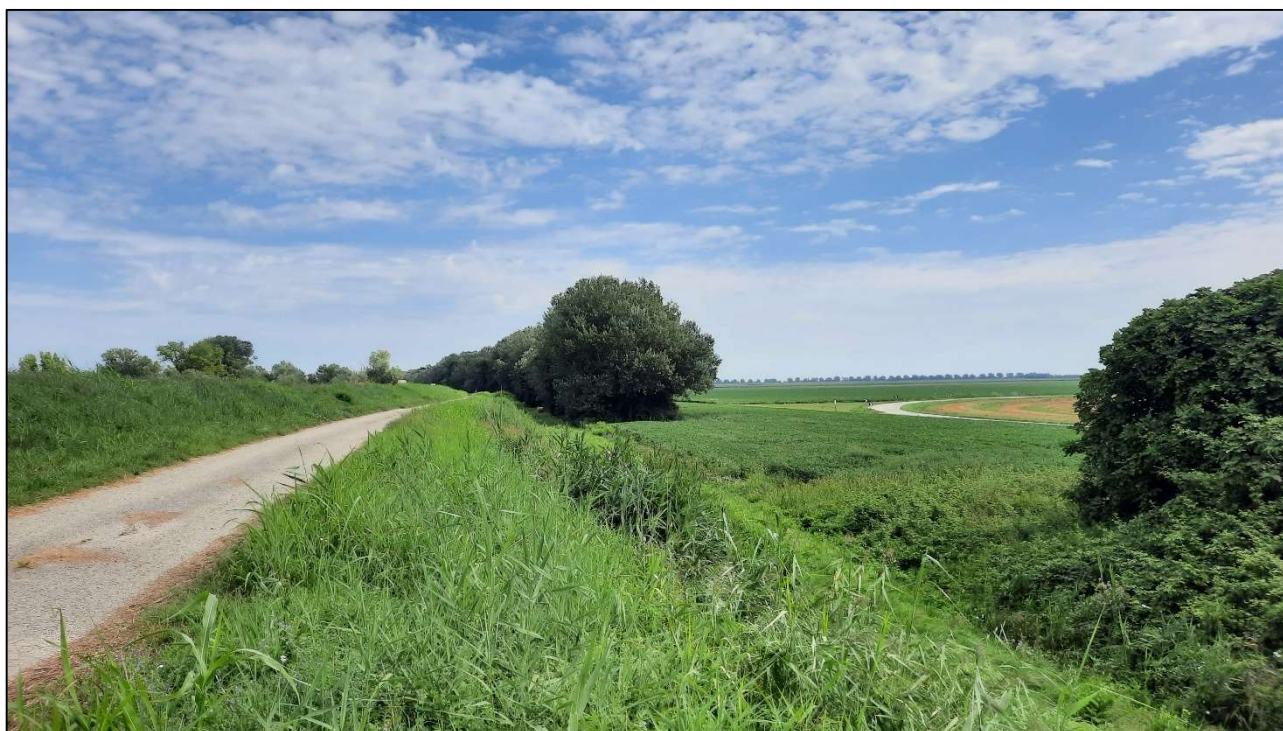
Stato dei luoghi – vista della sommità arginale (sulla sinistra della foto) di un tratto arginale interessato dall'intervento – stante 7-8.
